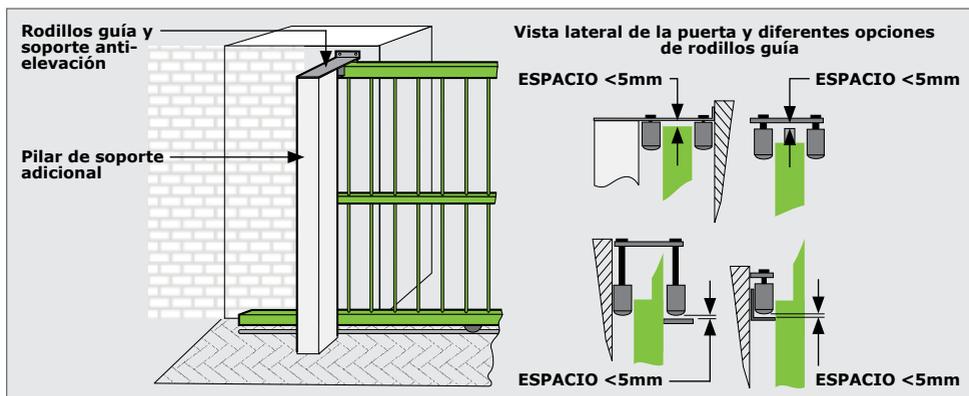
MONTAJE DE RODILLOS GUÍA
